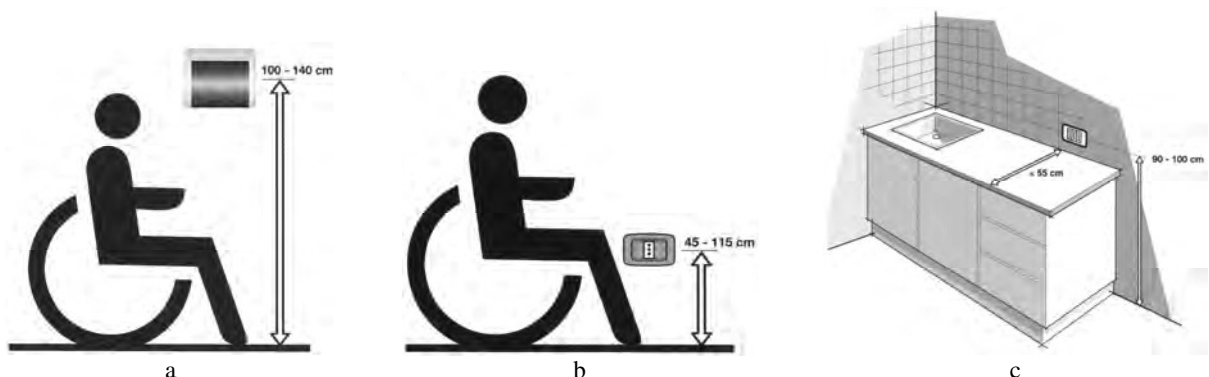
a) Altezza di installazione del quadro elettrico di un appartamento - b) Altezza di installazione delle prese - c) Distanze di installazione delle prese sopra i ripiani della cucina.
